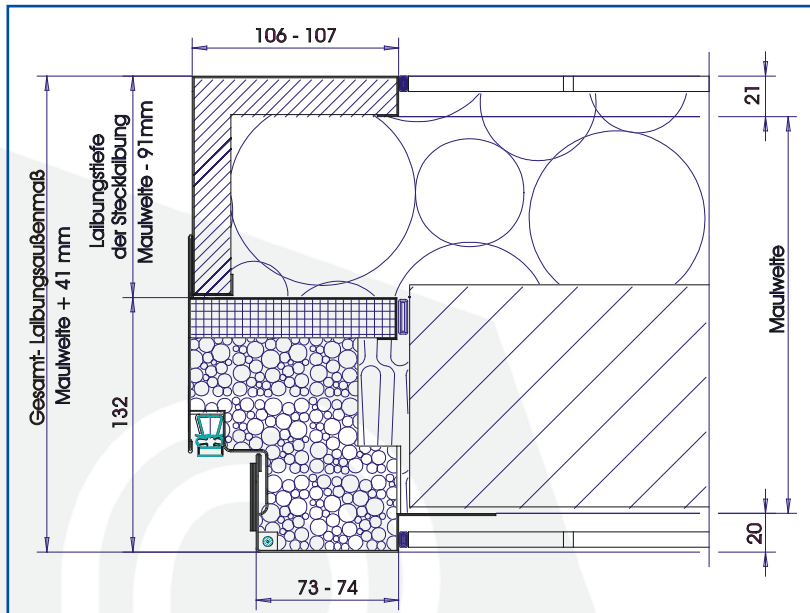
Einbausituation Variante 1 Stecklalbung
